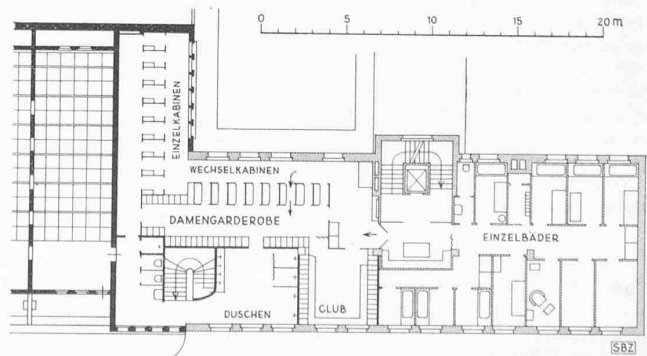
Grundriss Erdgeschoss, 1:400
